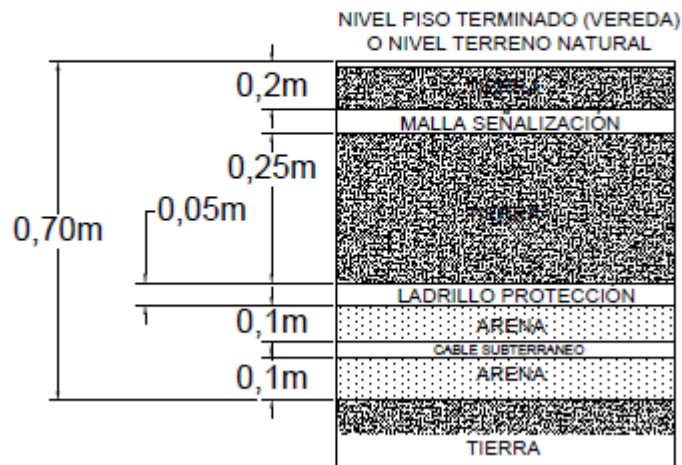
Detalle del tendido de Cable Subterráneo.
